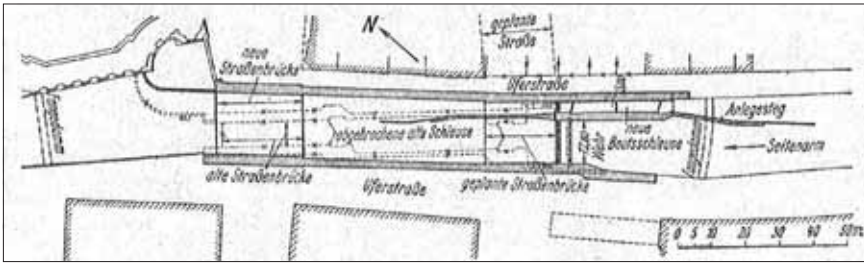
Lageplan der ehemaligen Schleuse im Spreekanal
